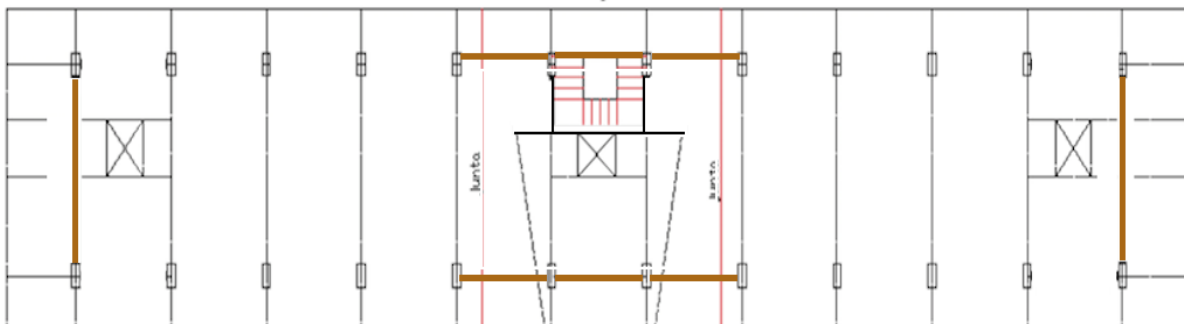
Disposição em planta da localização dos contraventamentos metálicos.
